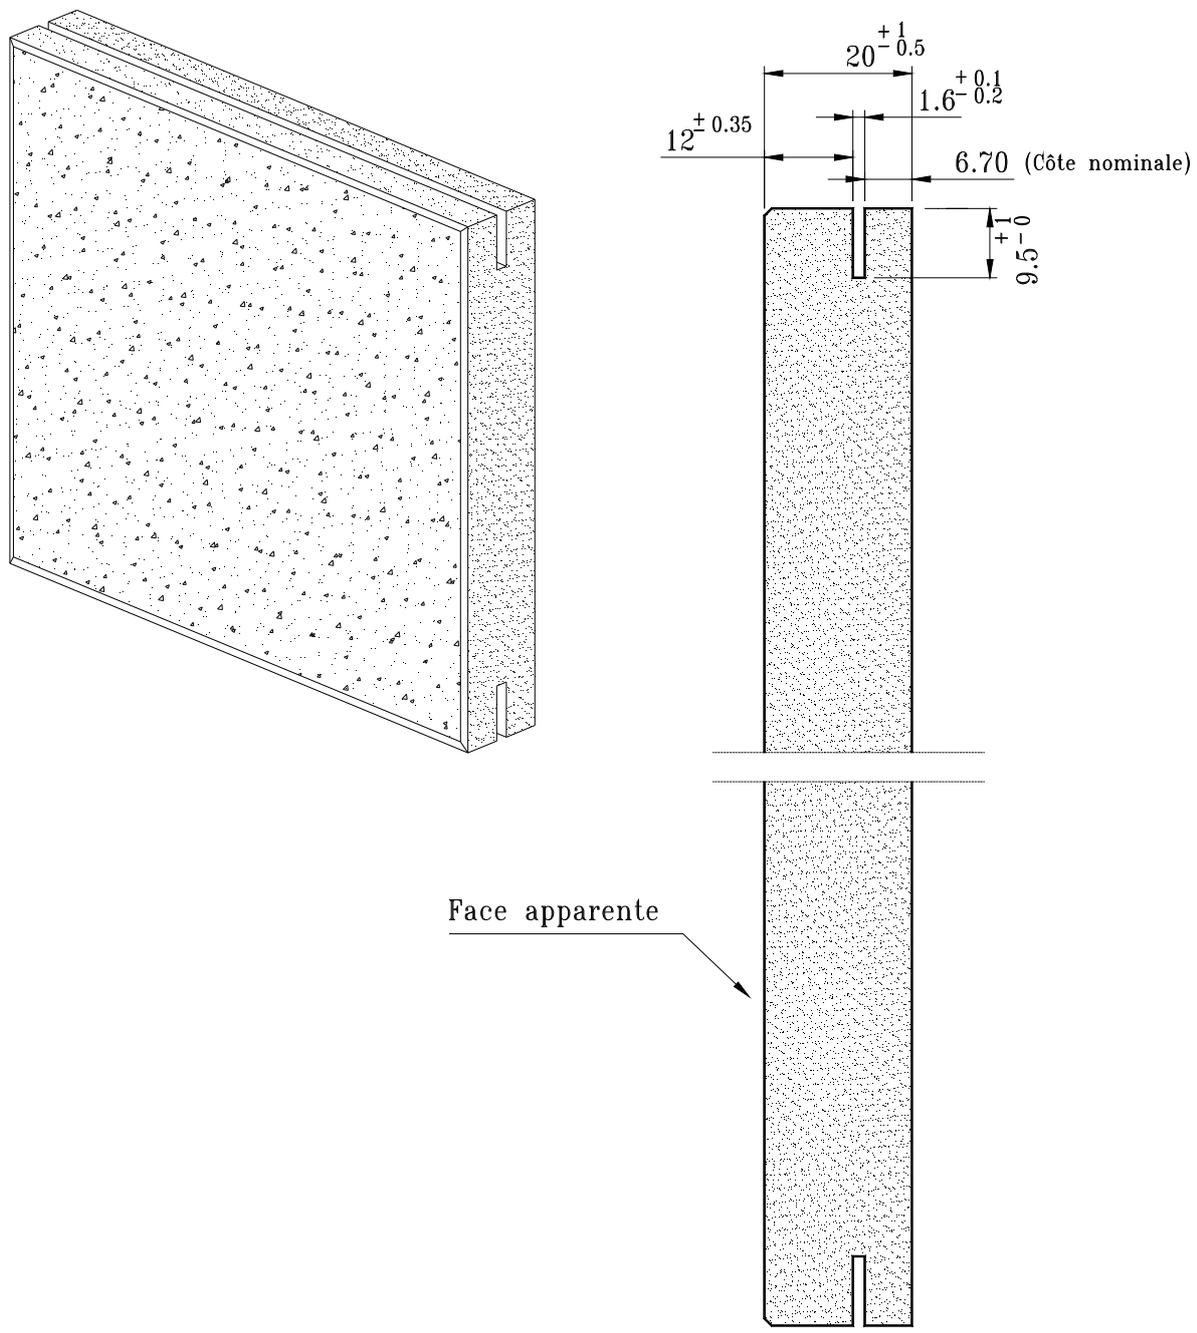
VETIRAIL CRISTO 20 mm-SB (soubassement)
